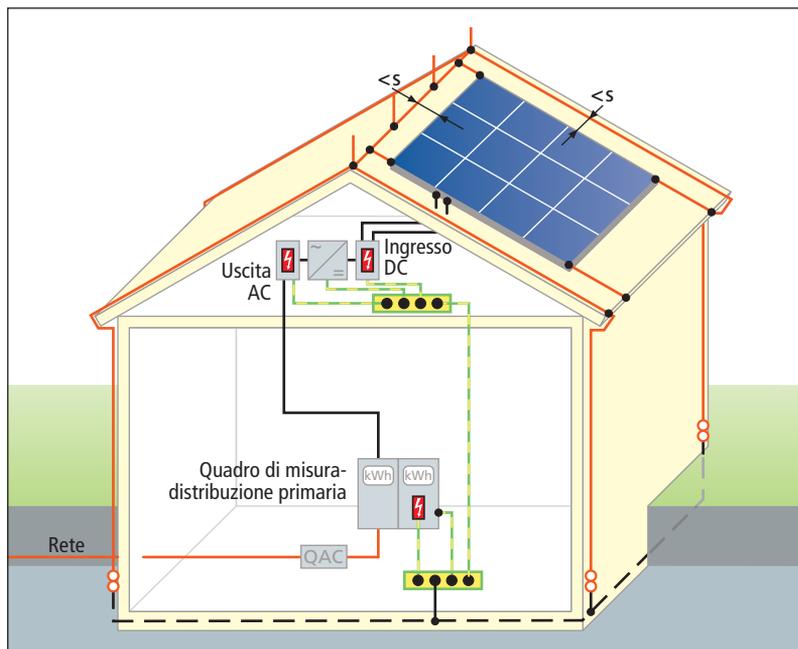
Concetto di protezione dalle sovratensioni per un impianto PV su un edificio con protezione contro i fulmini esterna senza rispetto della distanza di sicurezza s
